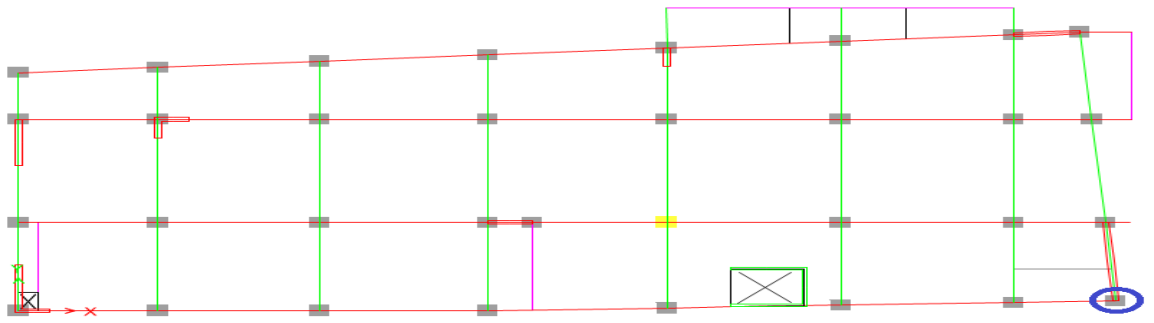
Localisation du poteau (C10) à étudier comme exemple de calcul au RDC (Vue plan ETABS)
